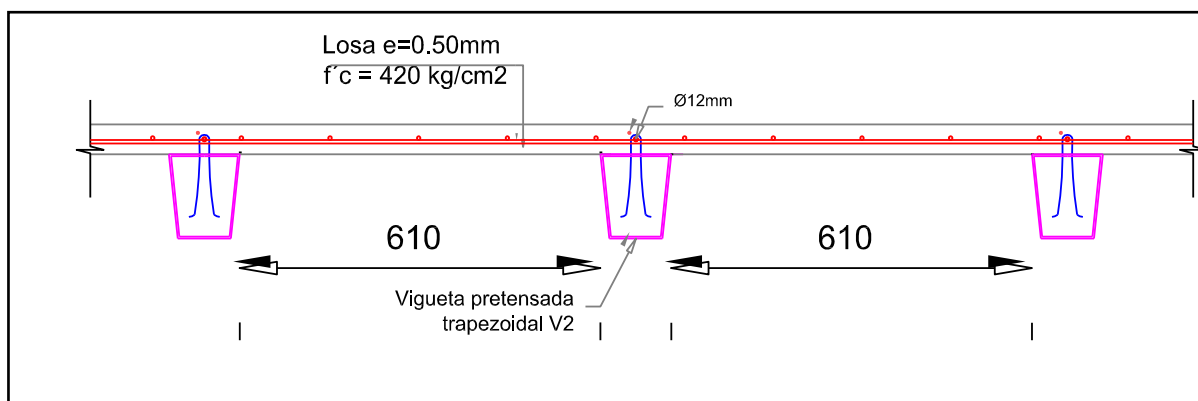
Vista transversal de la vigueta con la losa de compresión y el acero de refuerzo.
